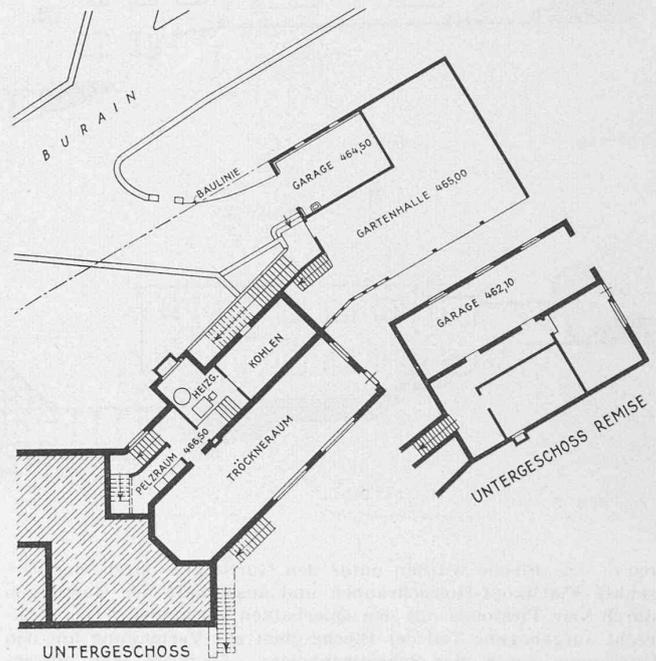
Grundrisse der Untergeschosse. — Masstab 1:400
